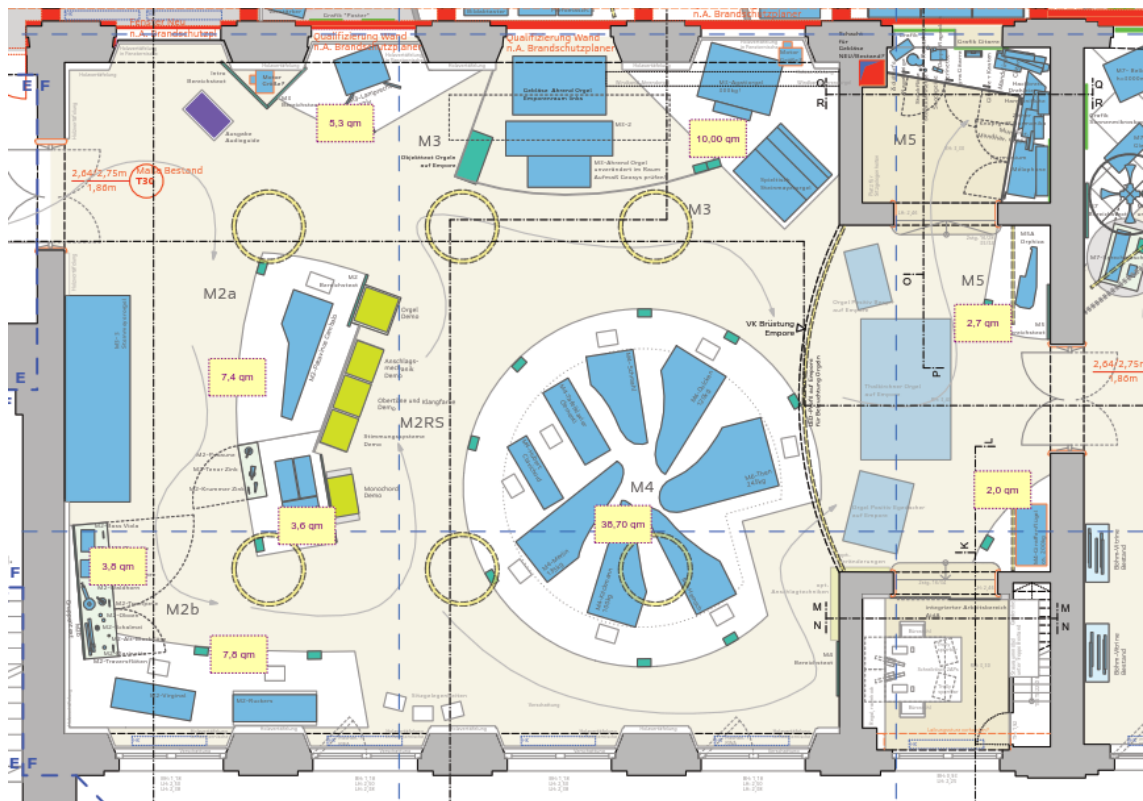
Grundriss mit geplanter Aufstellung der Instrumente inklusive Flächenangaben zu den Sockeln
